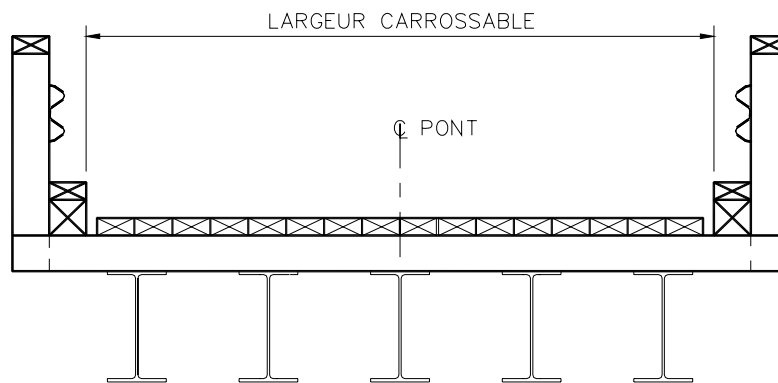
Coupe schématique d'un pont acier-bois à deux voies
